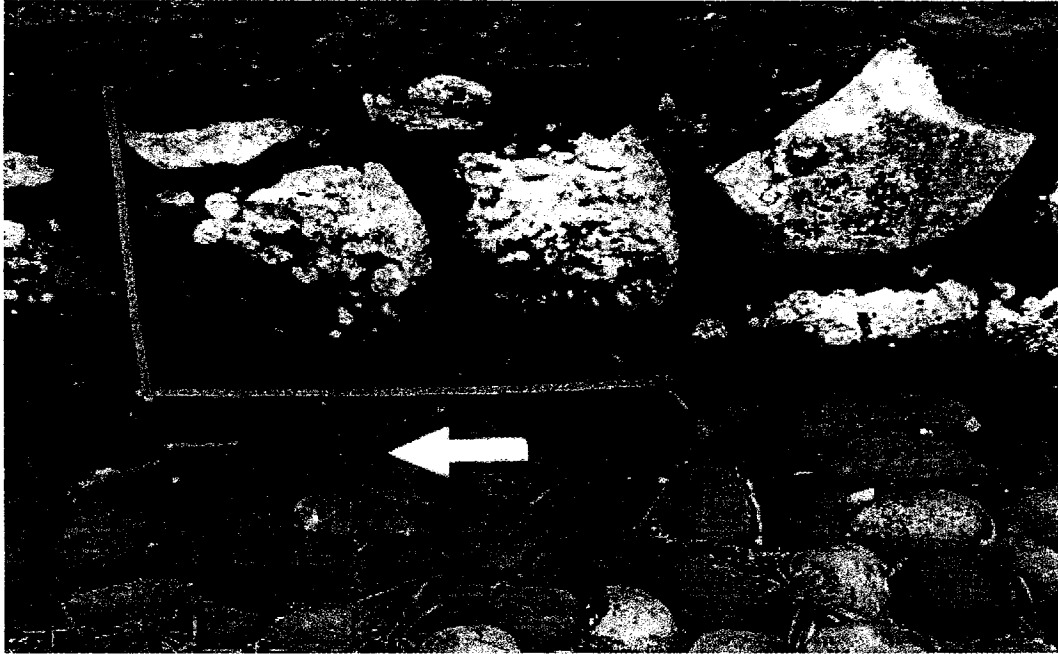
Nótese la disposición de las piedras del murete sobre el piso de cantos y la pega con cemento (parte superior).
